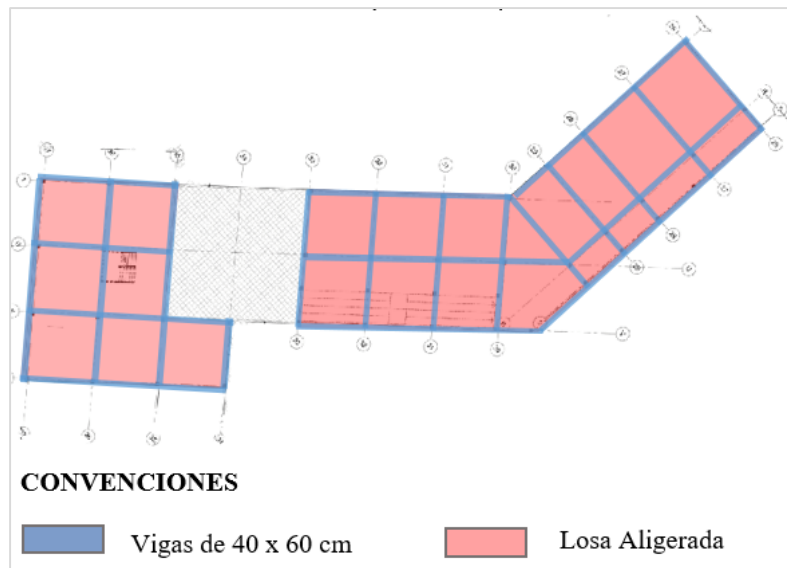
Planta Esquema Sistema Estructural en concreto por cada Bloque.
